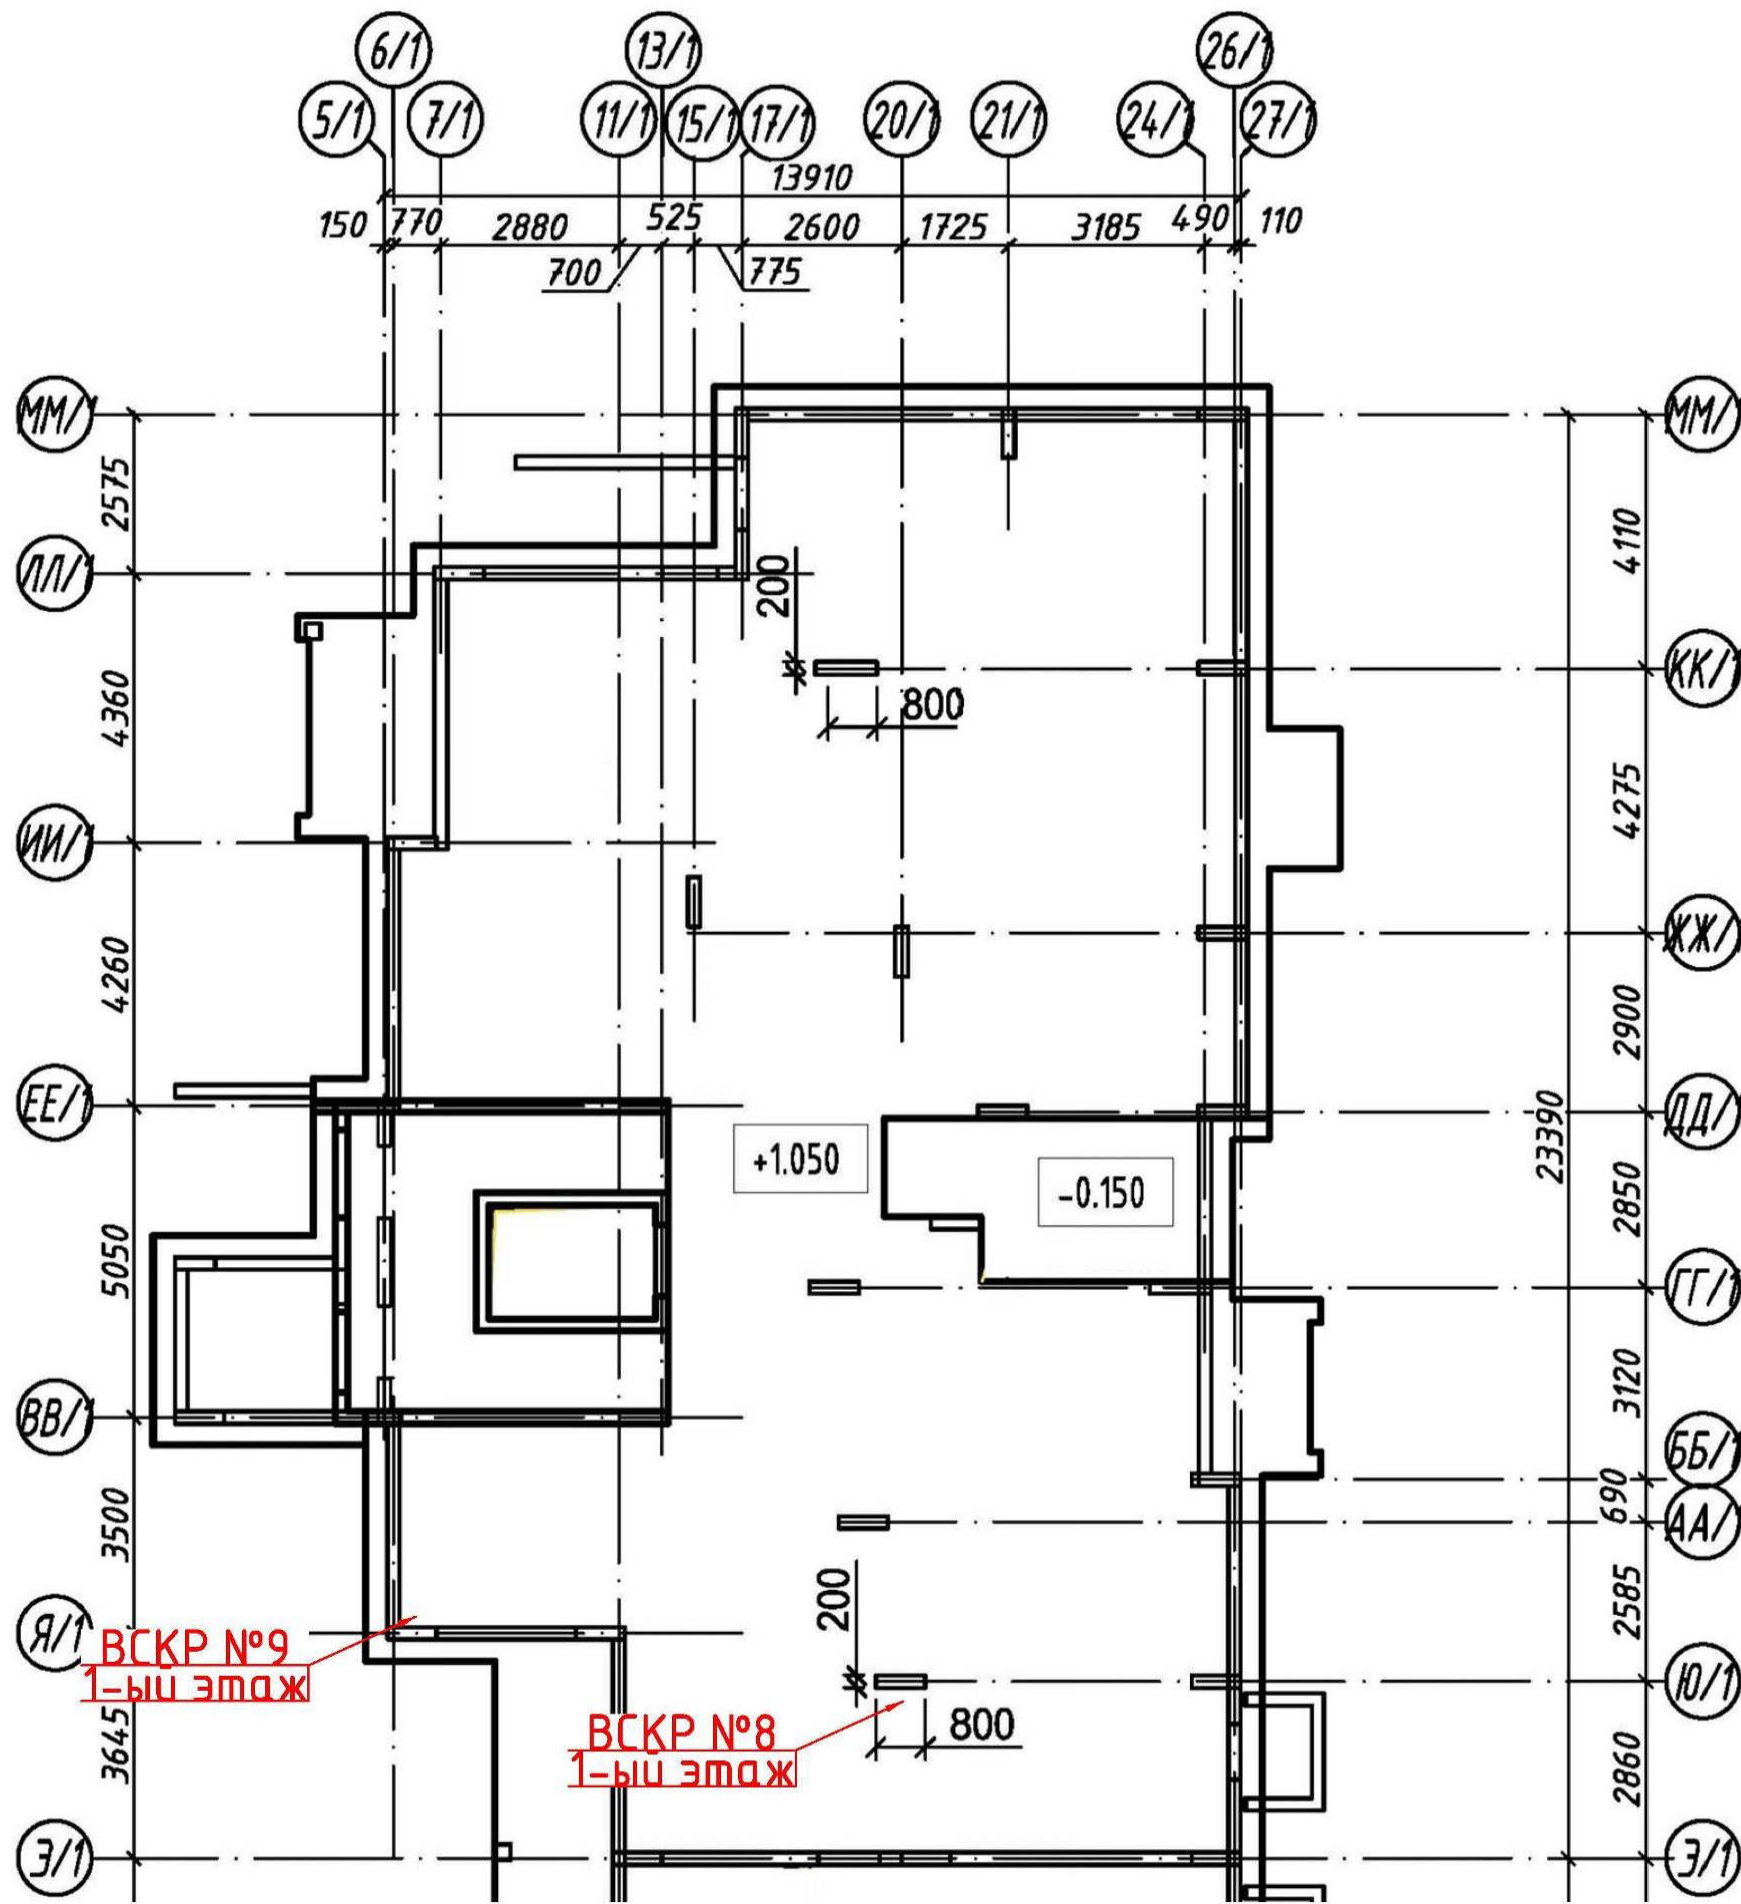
Схема расположения вскрытий конструкций 1-го этажа секции 1
